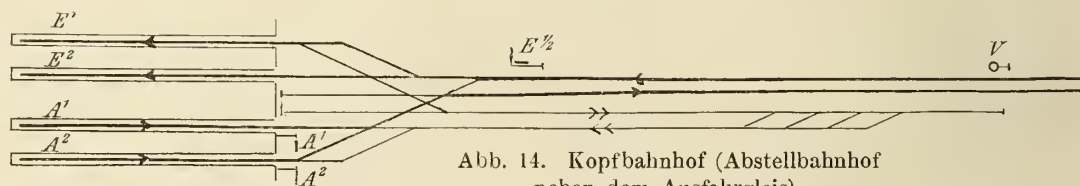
Kopfbahnhof (Abstellbahnhof neben dem Ausfahrgeleis).
